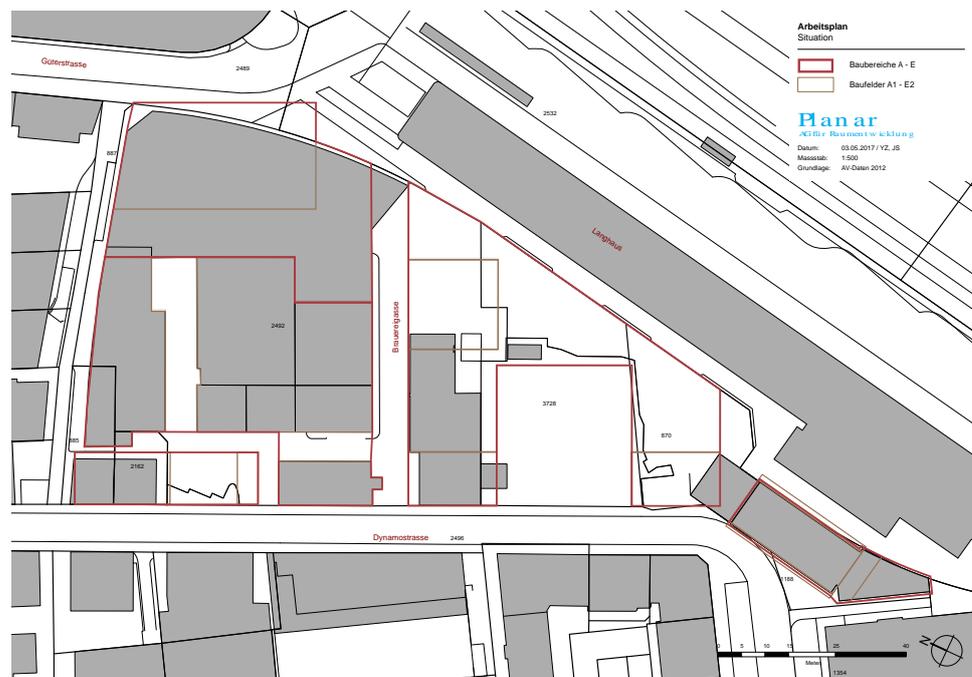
Bestehende Gebäude sowie Baubereiche und Baufelder (Quelle: PLANAR 2017)
